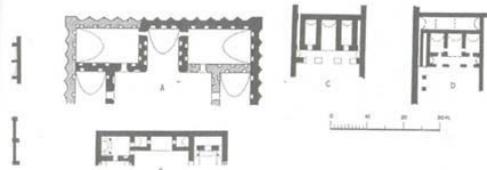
مسقط أفقي لقصر الأخيضر (عن كريزول).
